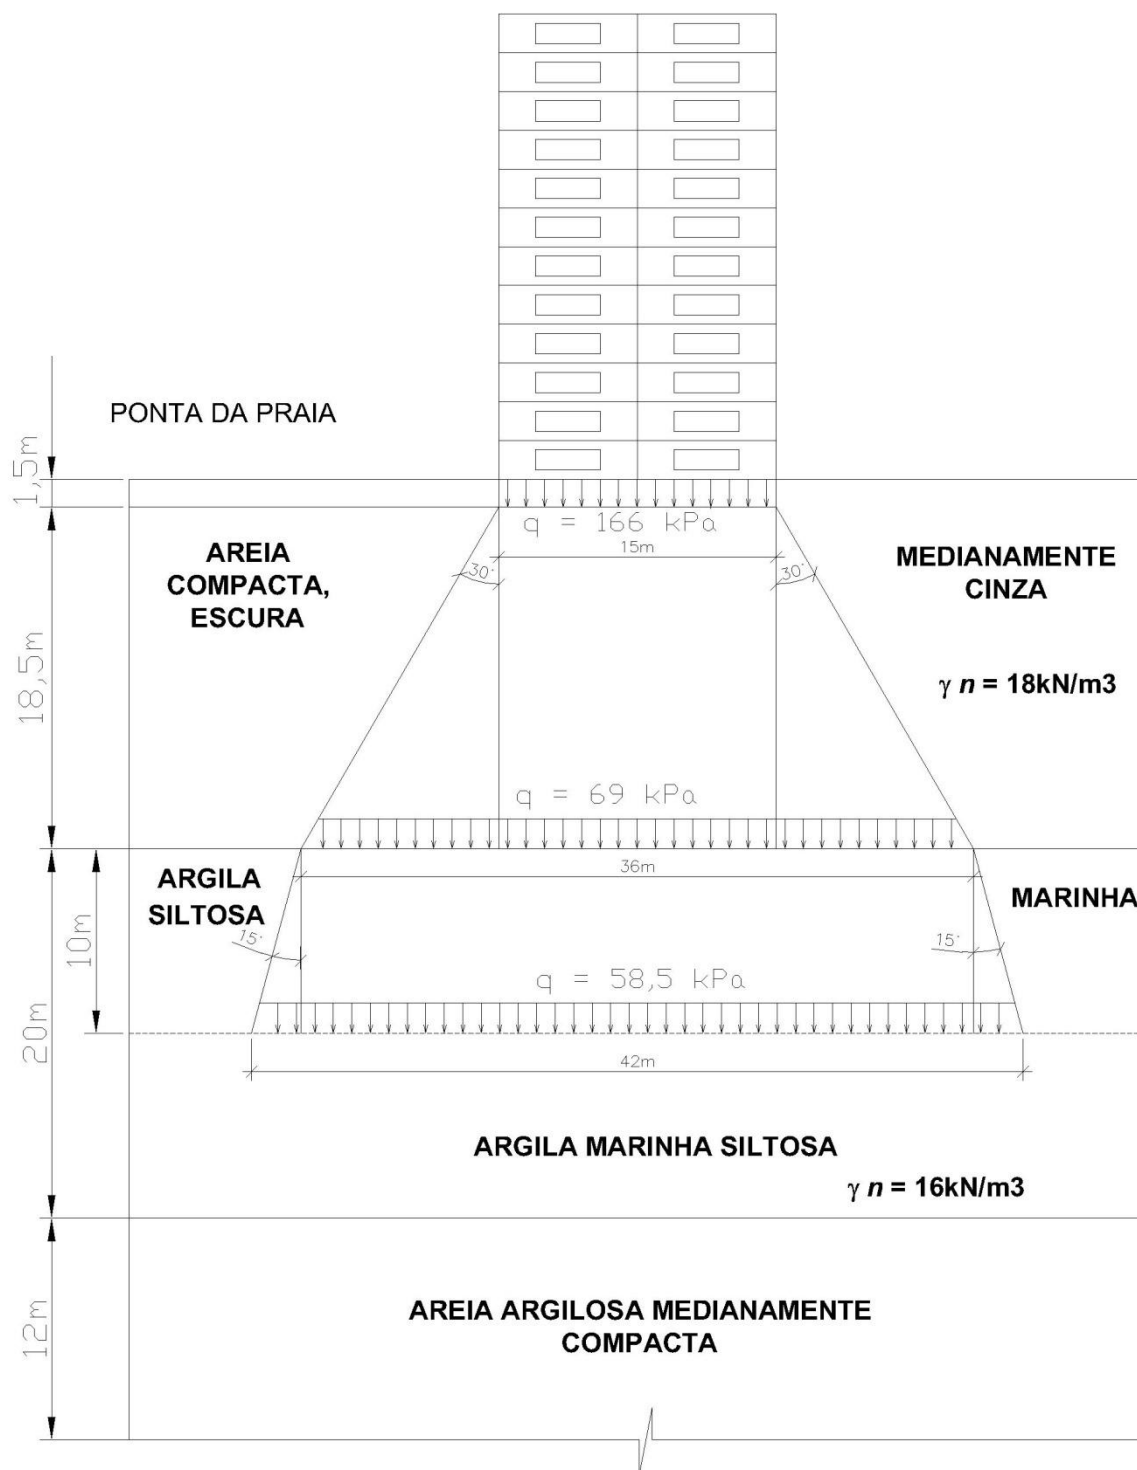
Esquema de dissipação de cargas para o perfil adotado da Ponta da Praia edifício "B", com 12 pavimentos
